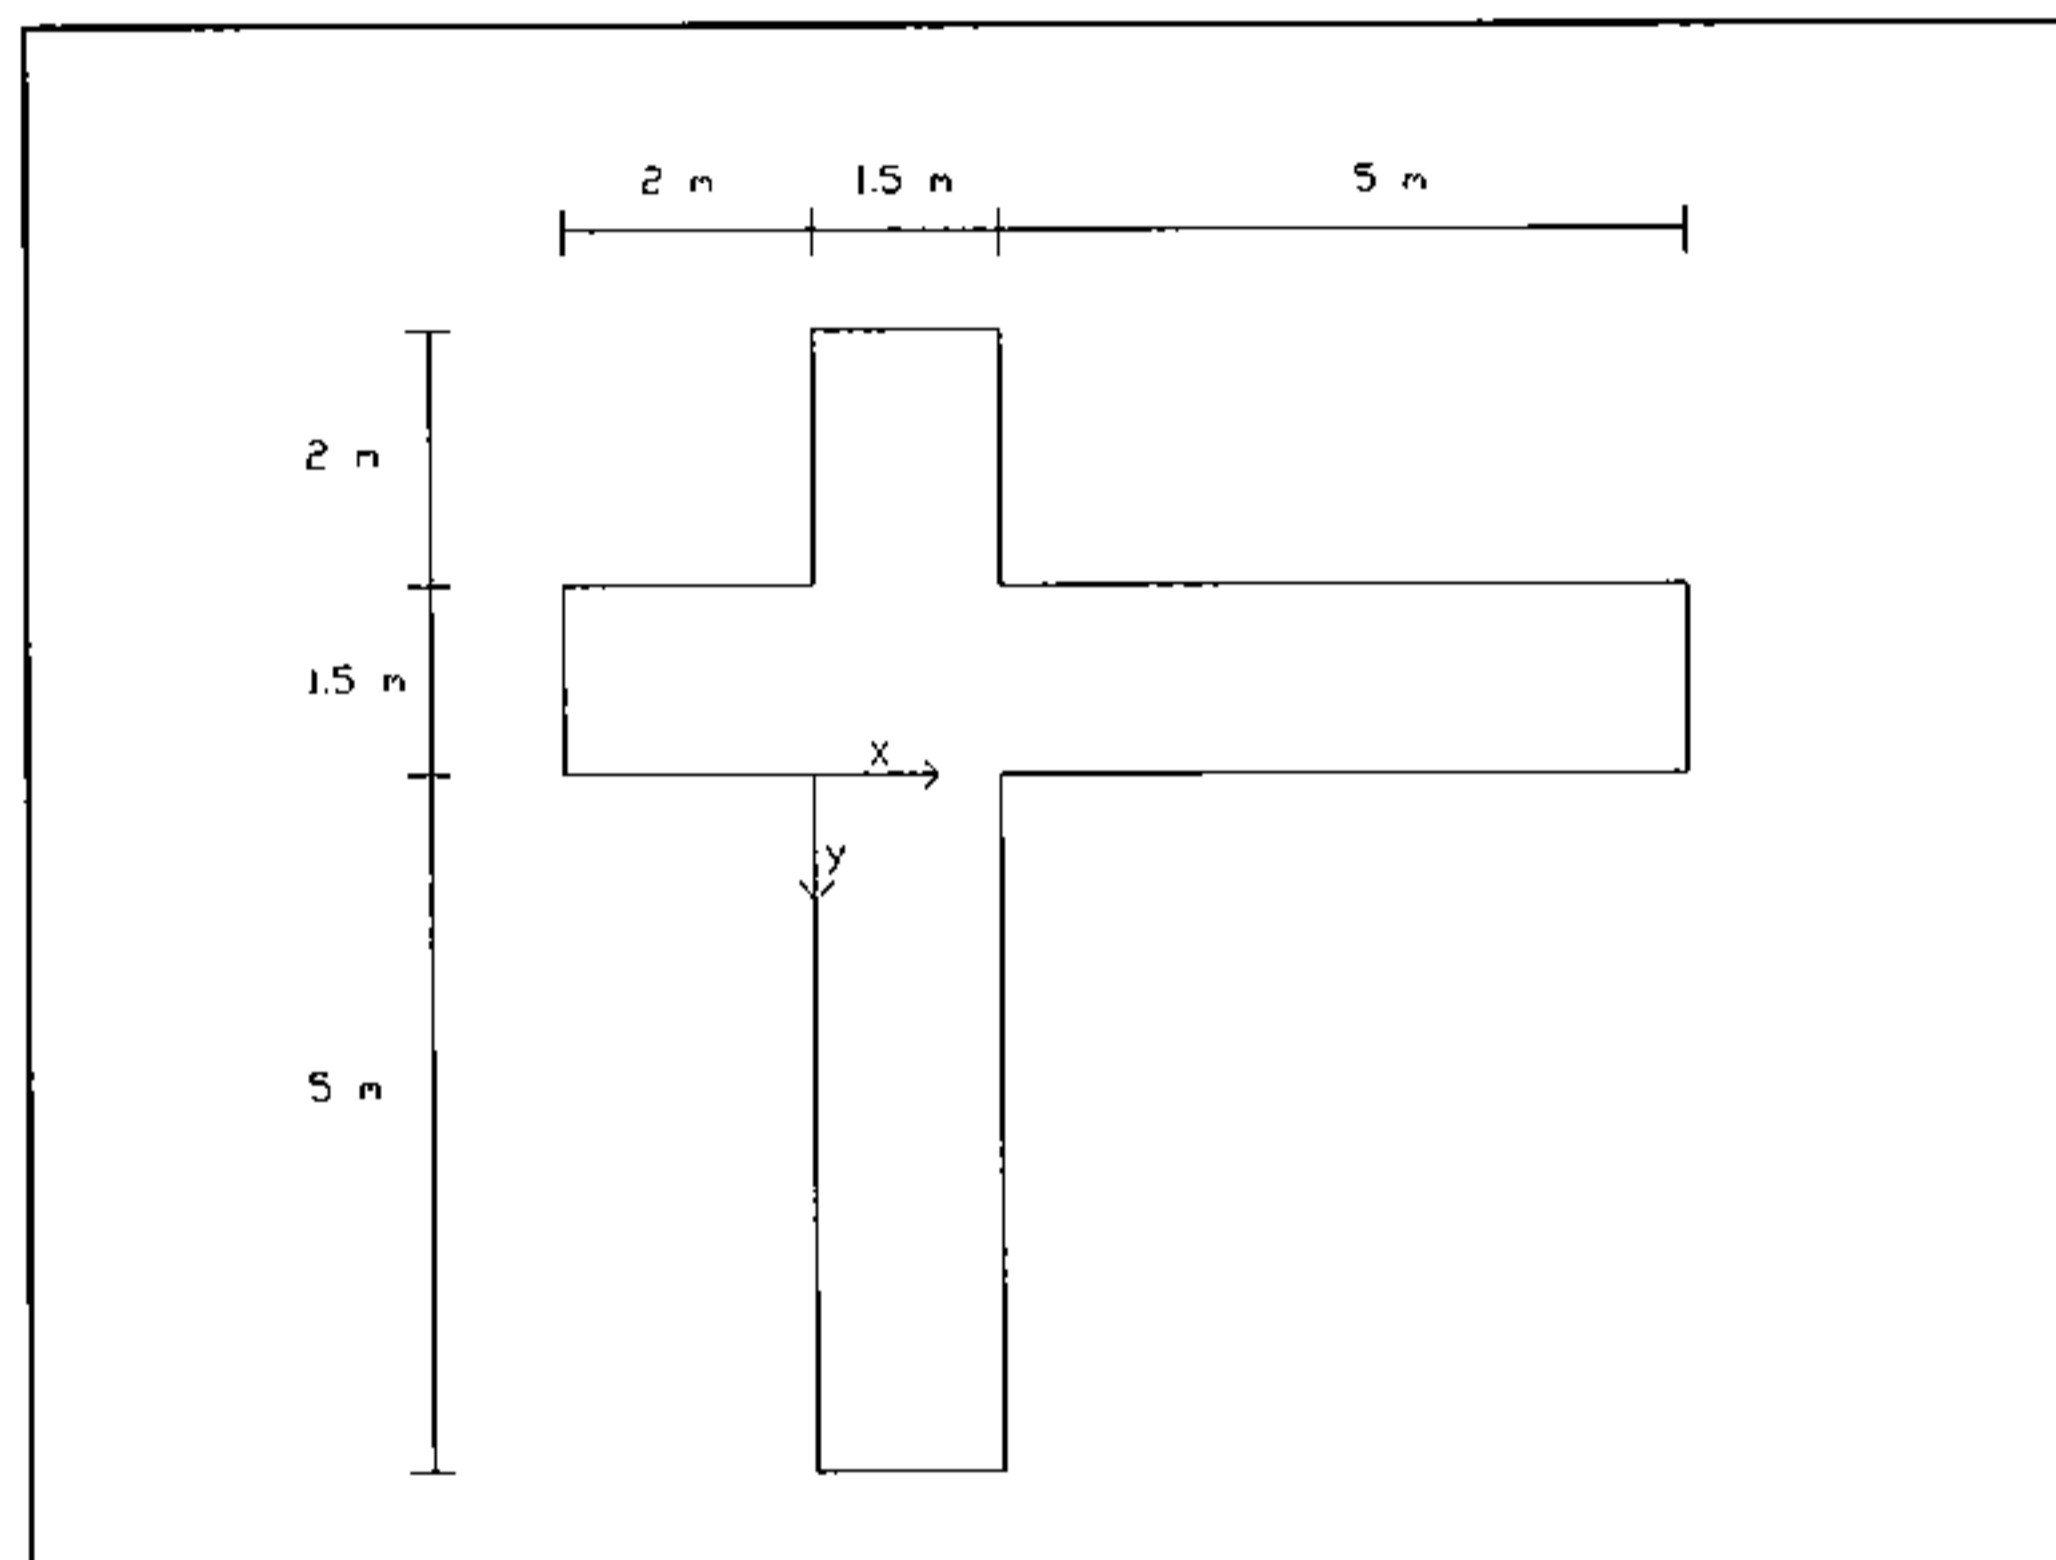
Geometría en planta de la instalación del cruce de calles
